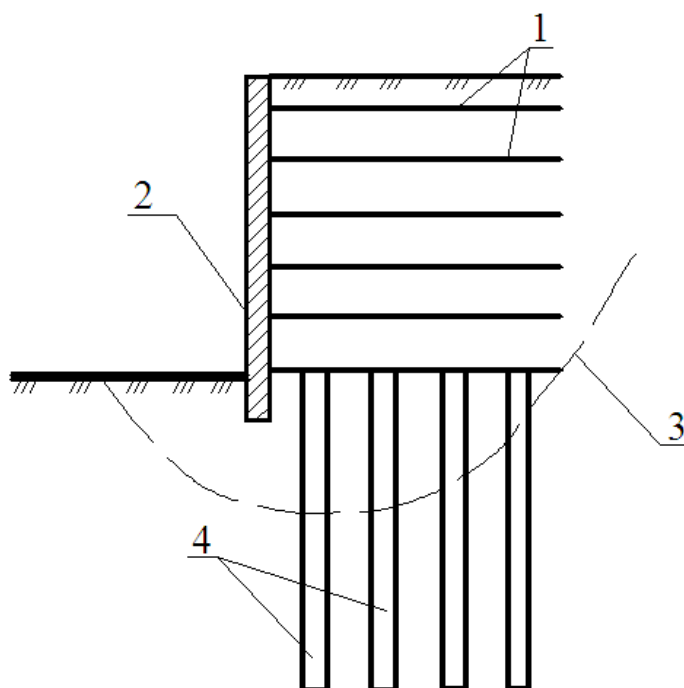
Схема обеспечения устойчивости высокой подпорной стенки из армированного грунта при помощи буроинъекционных вертикальных армирующих элементов
